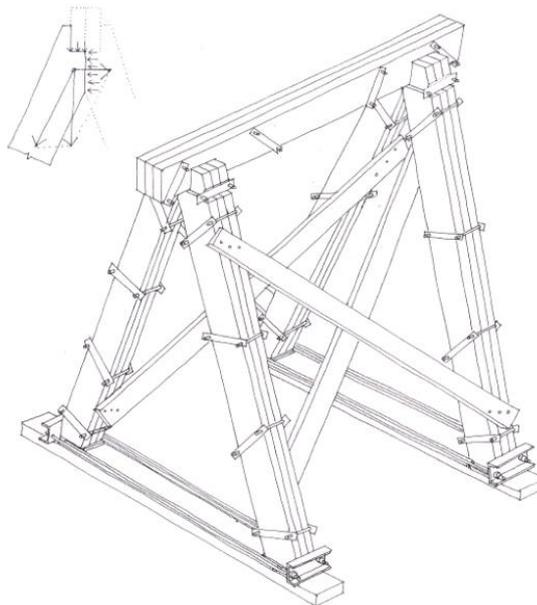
Detalle apeo de asnilla. Fuente: Espadasín, J. [1]
